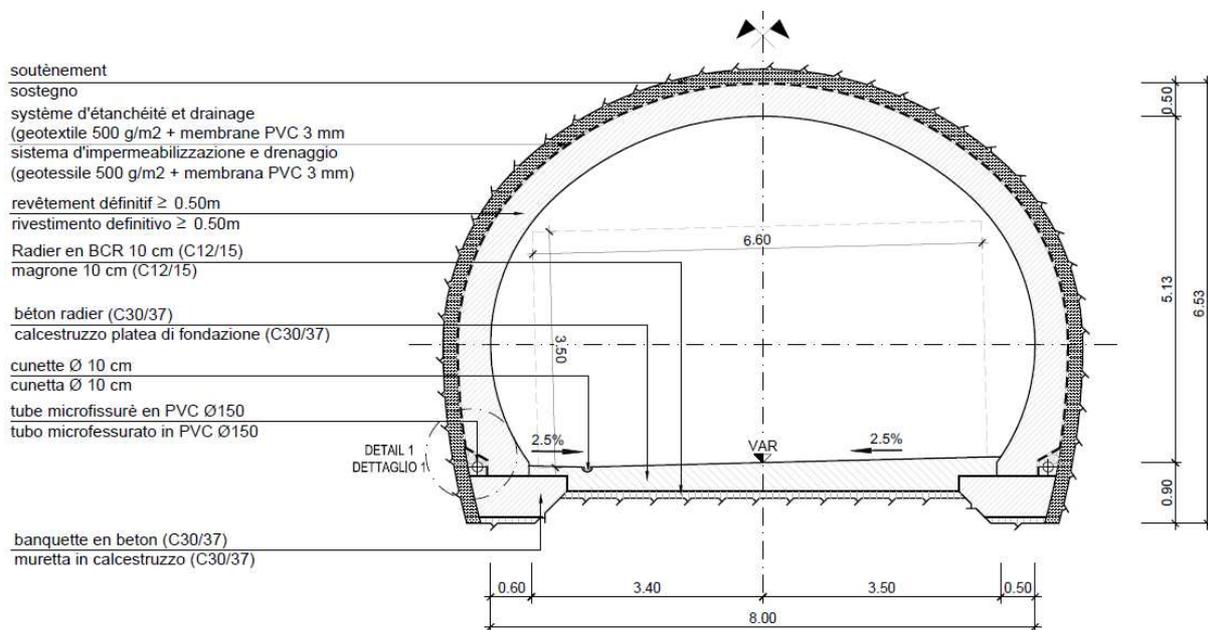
Galleria Logistica di inversione mezzi: sezione trasversale
